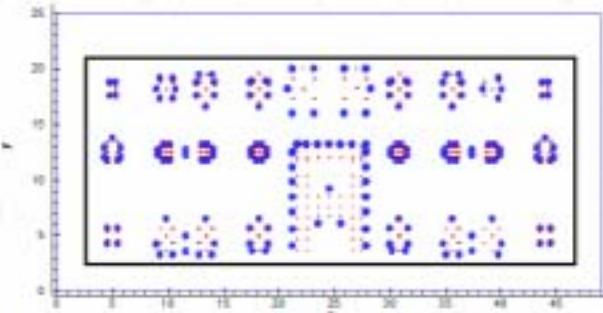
Схема с Громадским А.Н. свайного фундамента под жилым домом в городе Салехарде.
